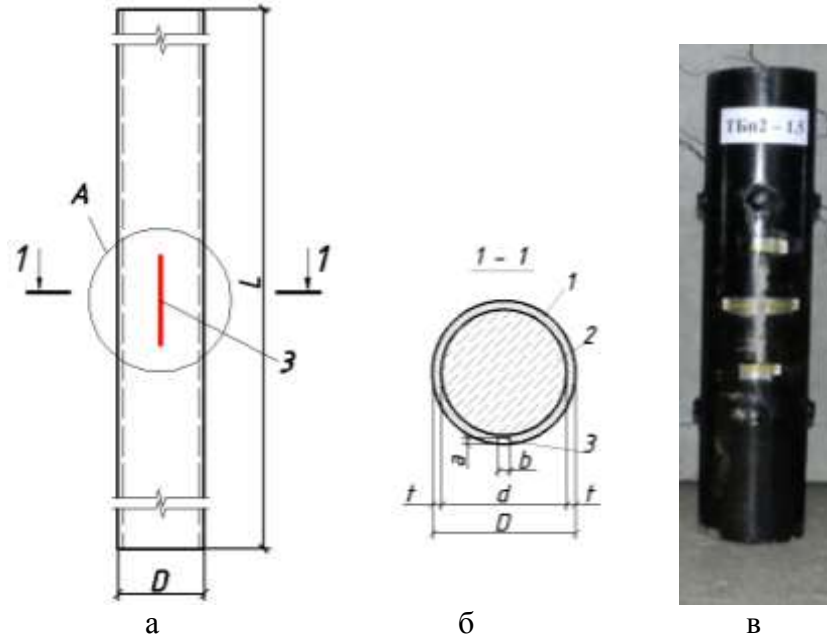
Трубобетонна стійка з пошкодженням труби-оболонки у виді вертикального вертикального прорізу: а, б – креслення трубобетонної стійки; в – фото дослідного зразка трубобетонного елемента
